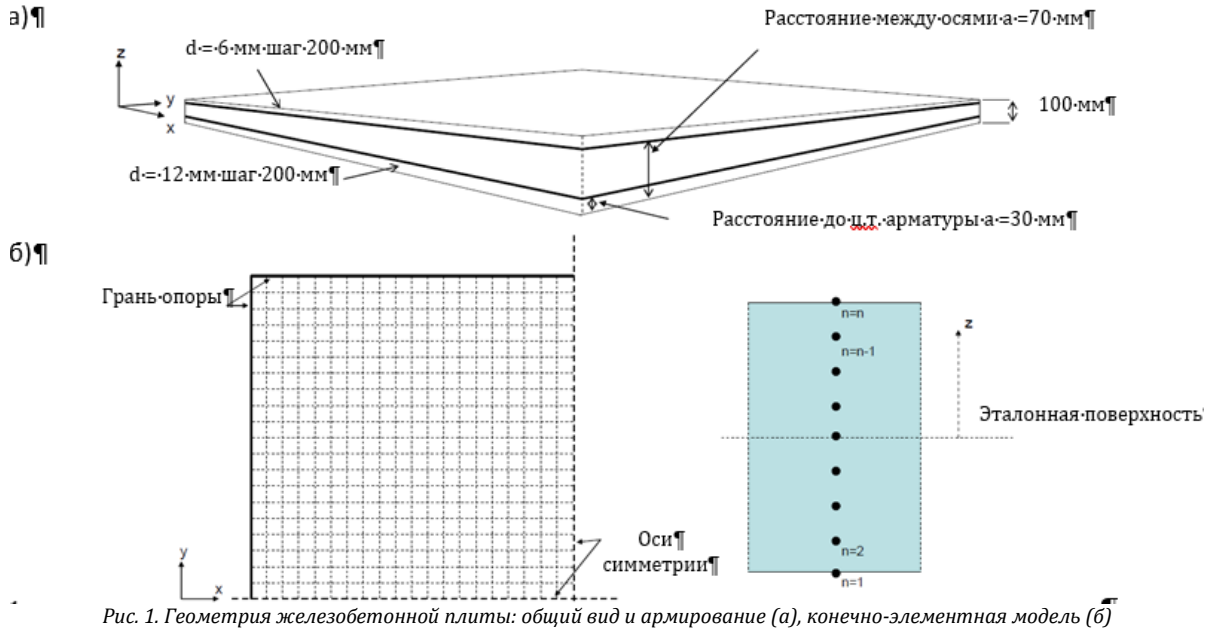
Геометрия железобетонной плиты: общий вид и армирование (а), конечно-элементная модель (б)
